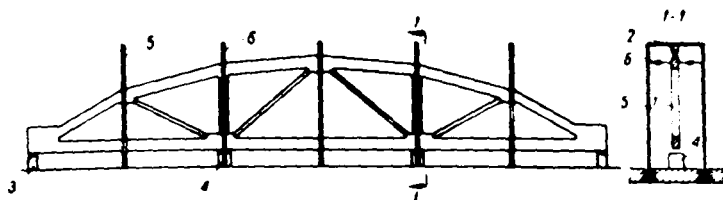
Стелд для испытания ферм и балок в вертикальном положении
